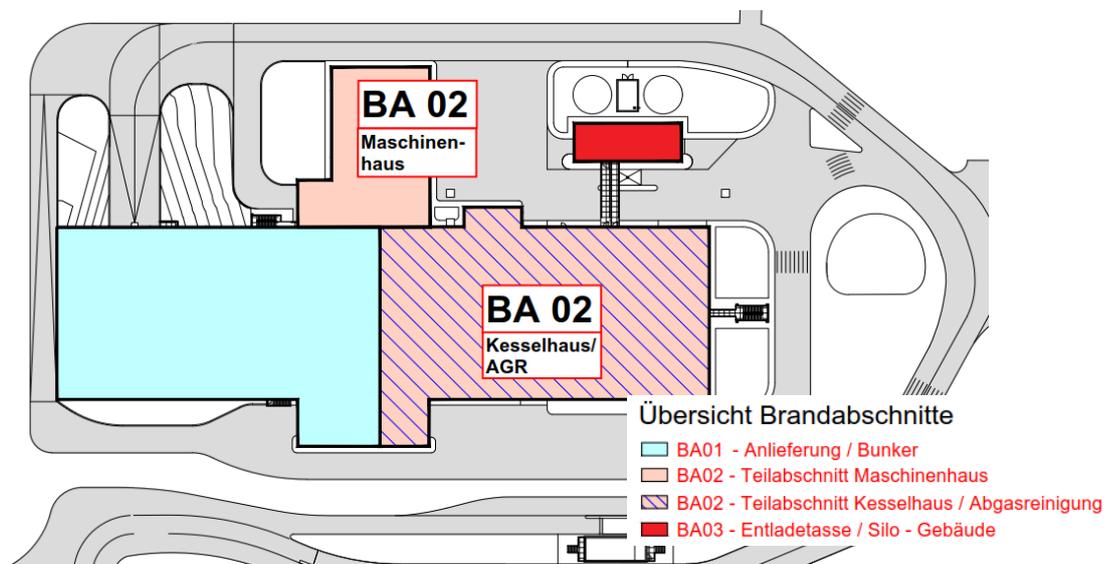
Lage Brandabschnitt BA 02 – Kesselhaus/Abgasreinigung/Maschinenhaus
